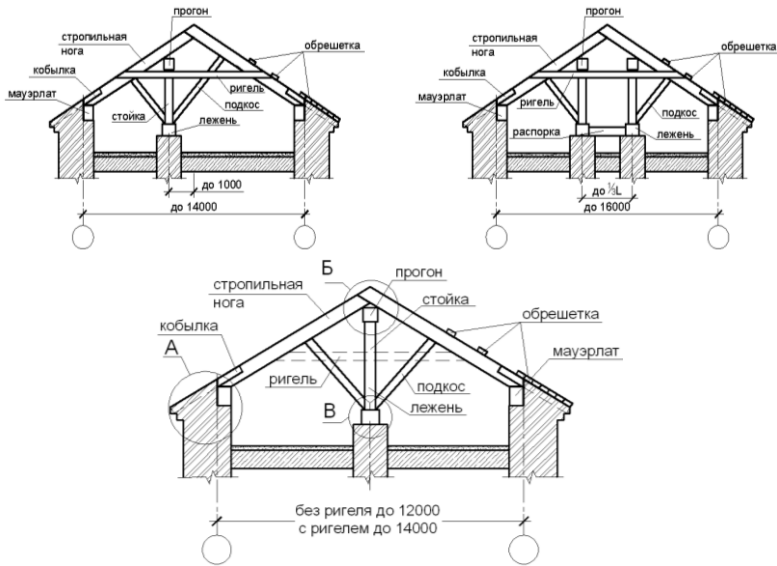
Конструктивные схемы двускатных крыш с наслонной стропильной системой
